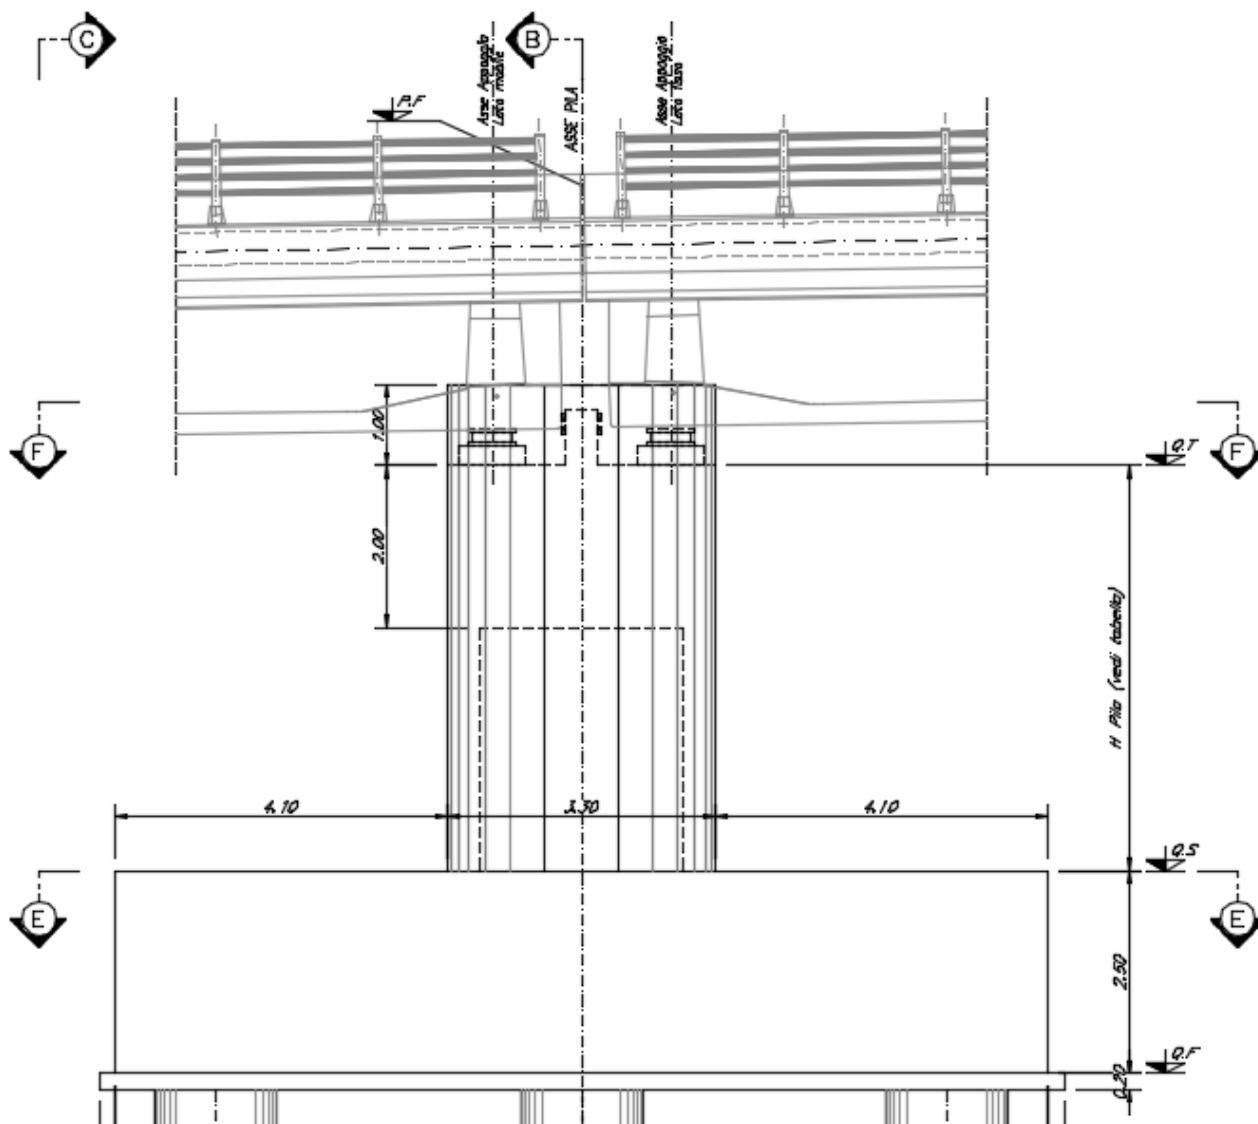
Pila scatolare singolo binario – prospetto longitudinale
